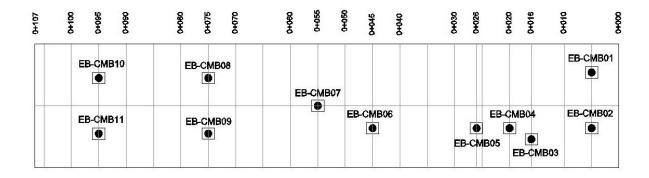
Localización de los Extensómetros de barra en la Bóveda en Casa de Máquinas
